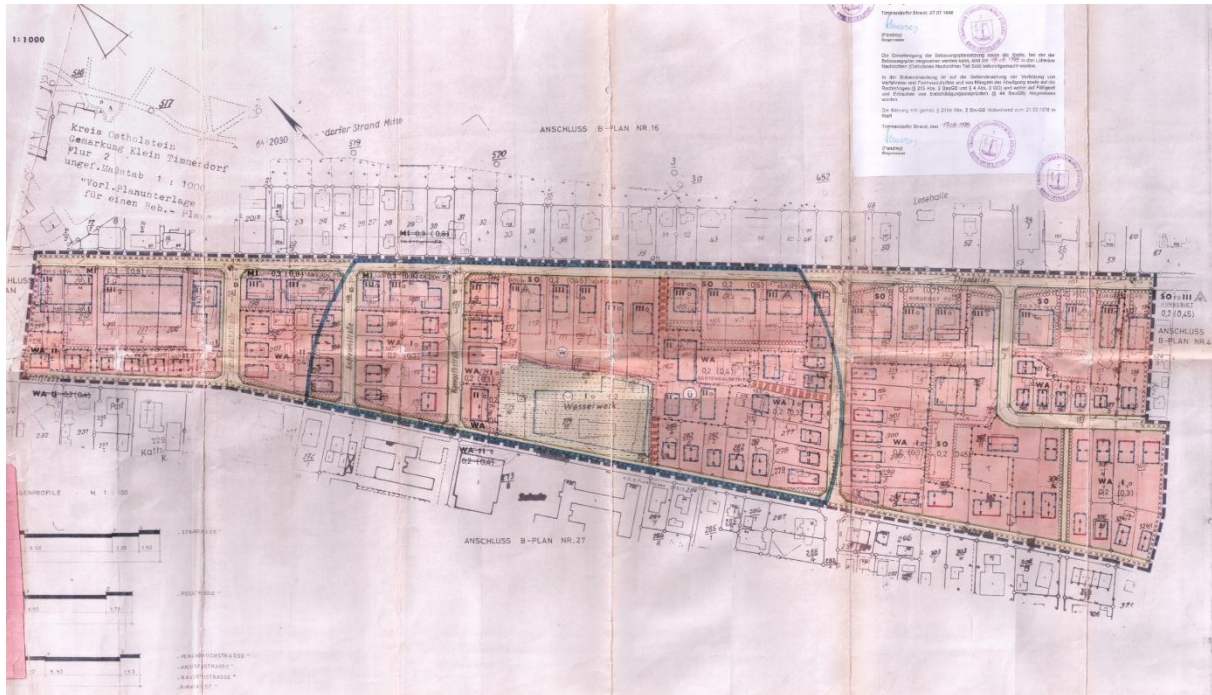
Bebauungsplan Nr. 19 aus dem Jahr 1976
